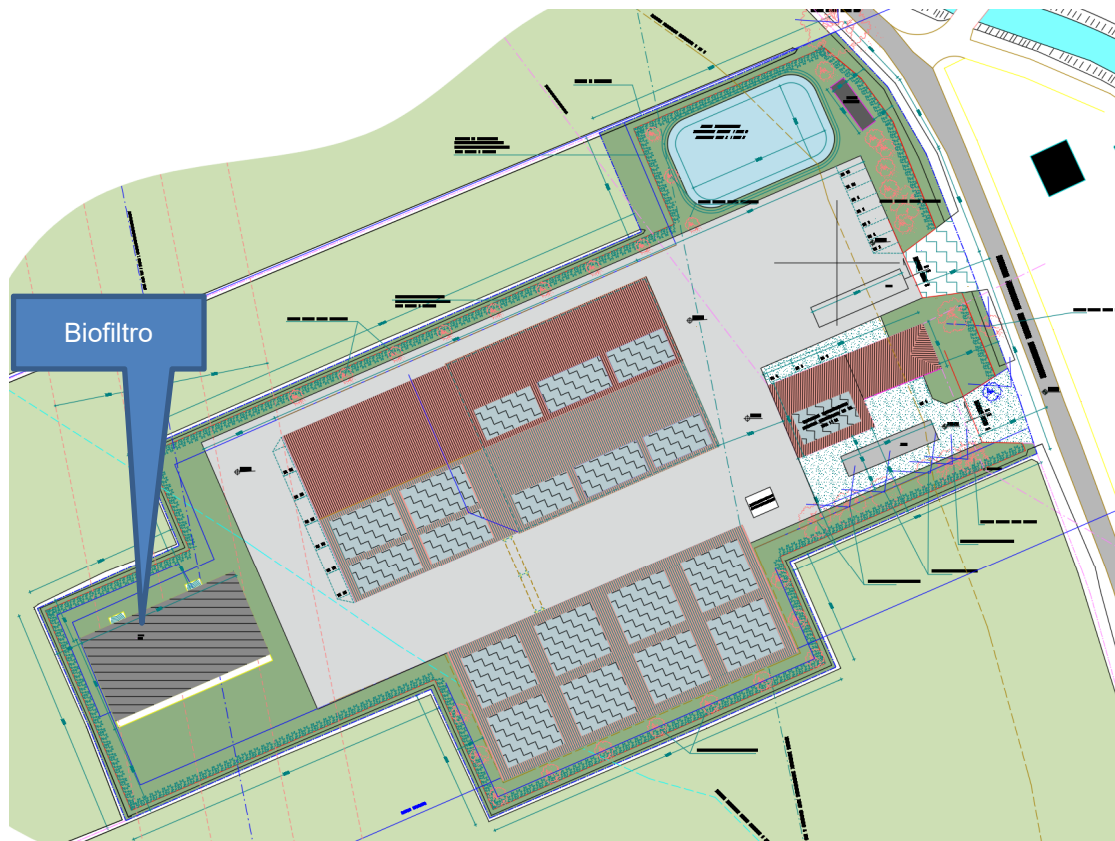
Estratto della planimetria di progetto con indicazione della posizione del biofiltro.
